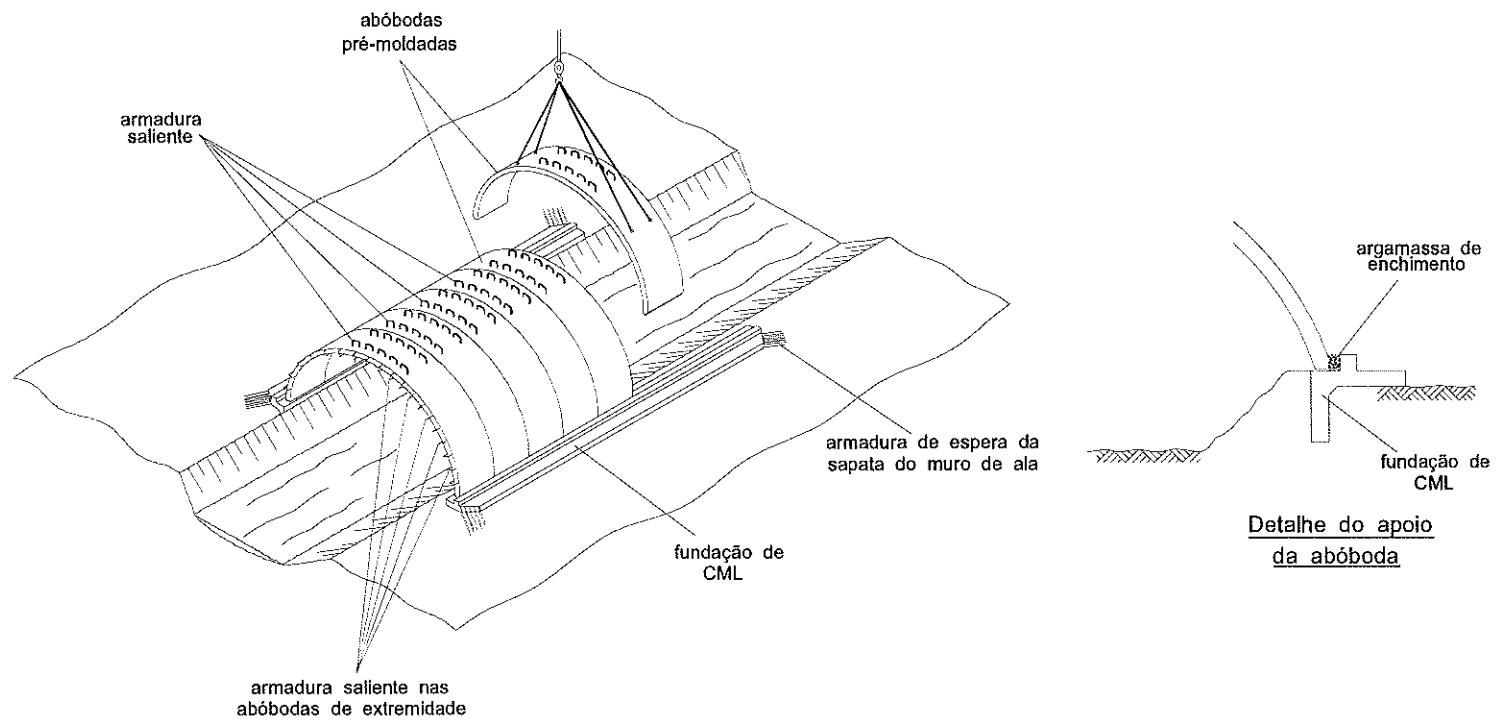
Colocação das abóbadas pré-moldadas sobre fundação de concreto moldado no local
